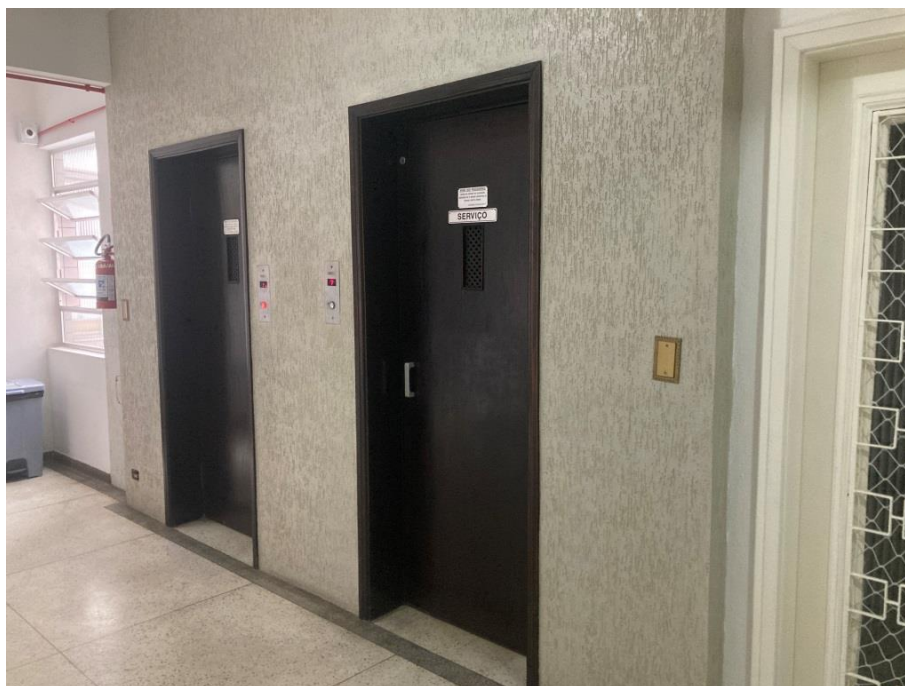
Hall dos elevadores no pavimento do apartamento avaliando
